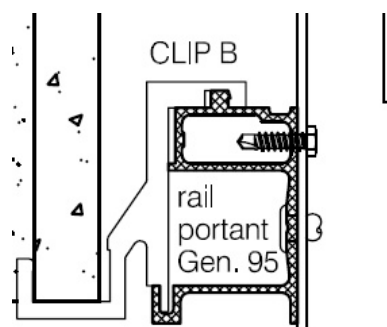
is - Fixation du rail pour bardeaux > 1m²
